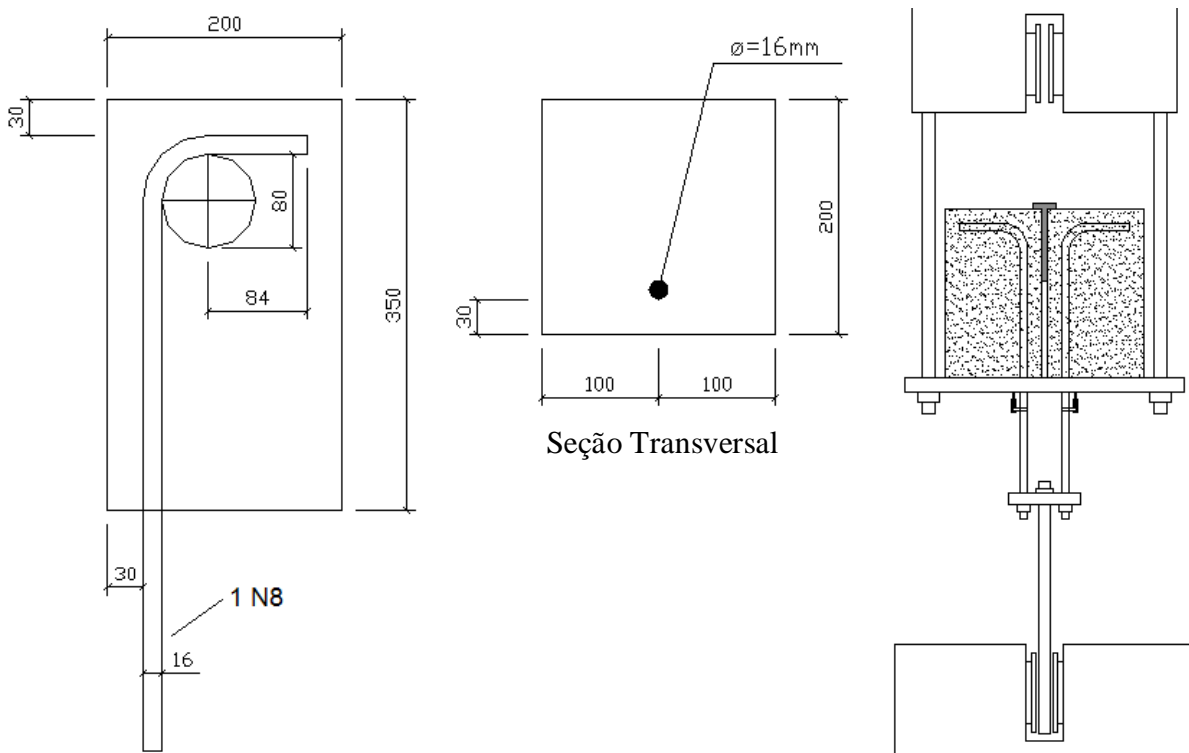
Formas do modelo de arrancamento com barras de 16 mm com gancho (dimensões em mm)
